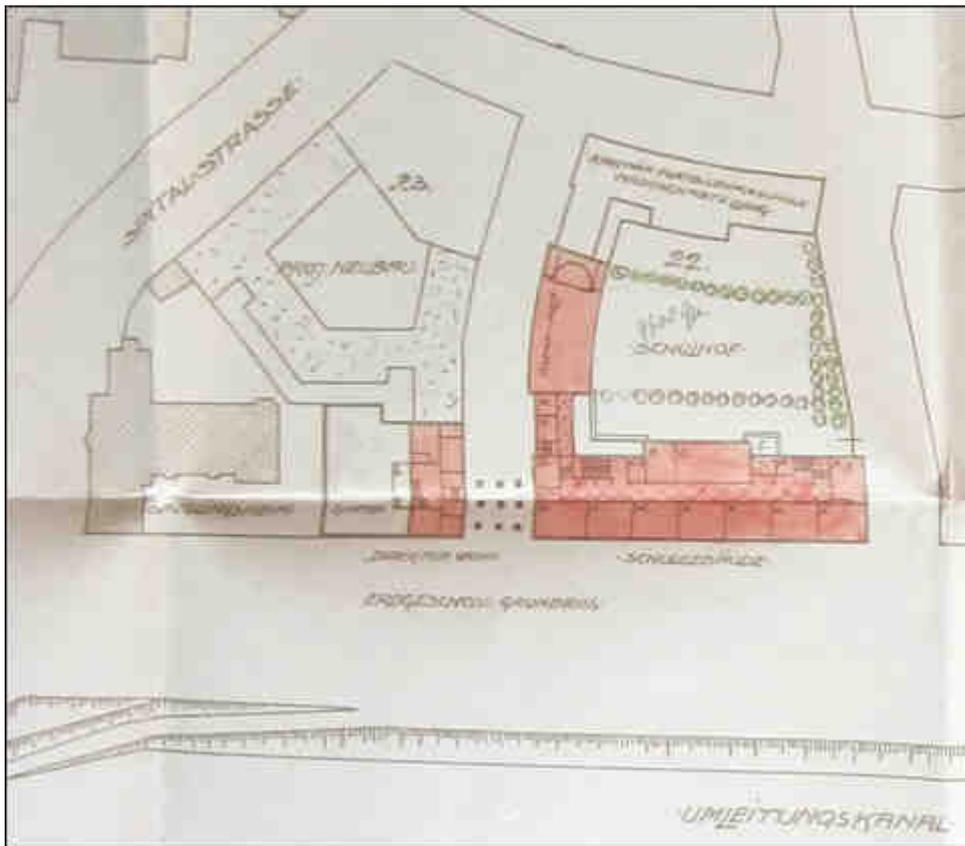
Plan de masse du projet de construction pour une seconde école municipale supérieure de filles à Strasbourg (parties colorées au centre et à droite) en 1914 (avant-projet de l'architecte Beblo, 28.03.1914, AMS 2MW581).
